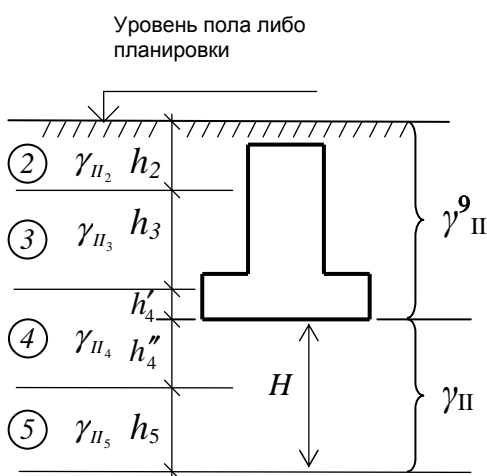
Схема к расчету удельных весов грунта, расположенных выше и ниже подошвы фундамента по формуле (7)
